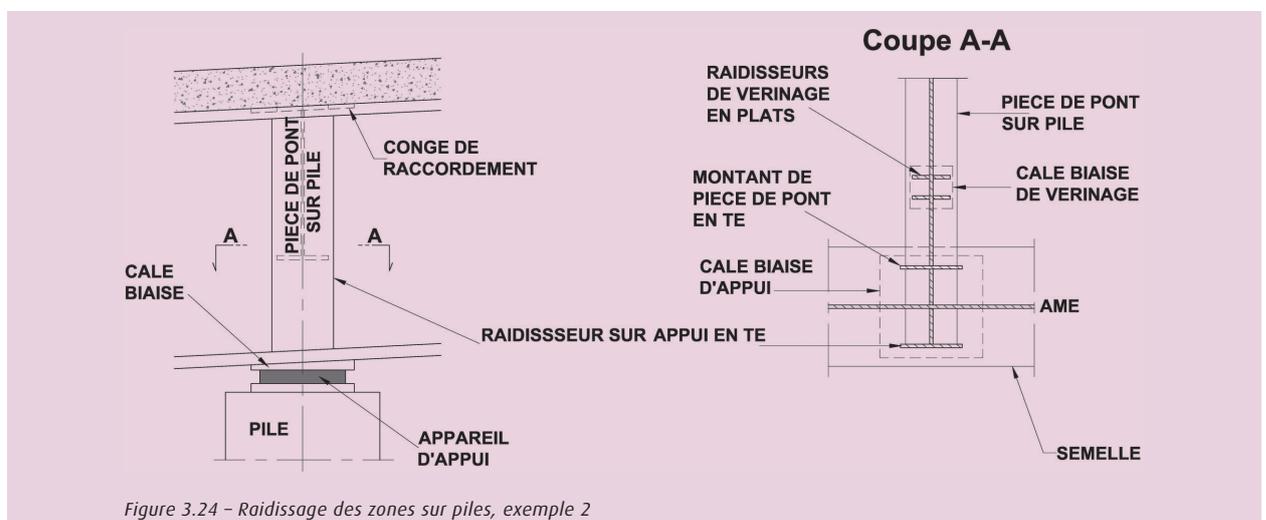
Raidissage des zones sur piles, exemple 2
